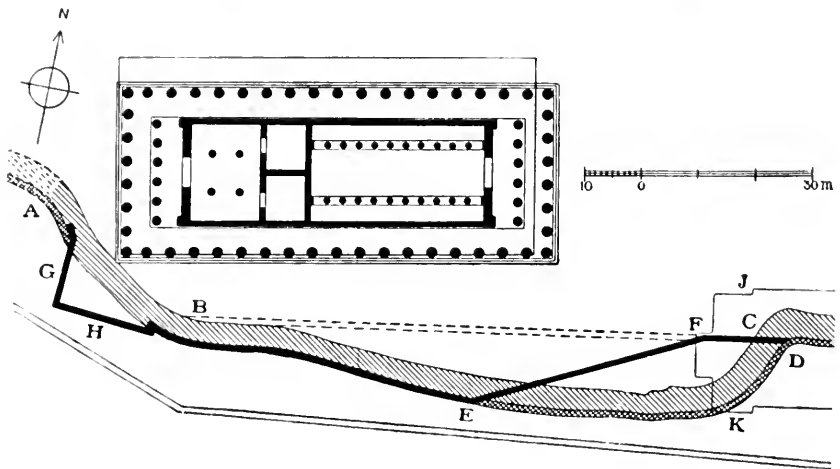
Grundriss des Parthenon und seiner südlichen Terrasse.
